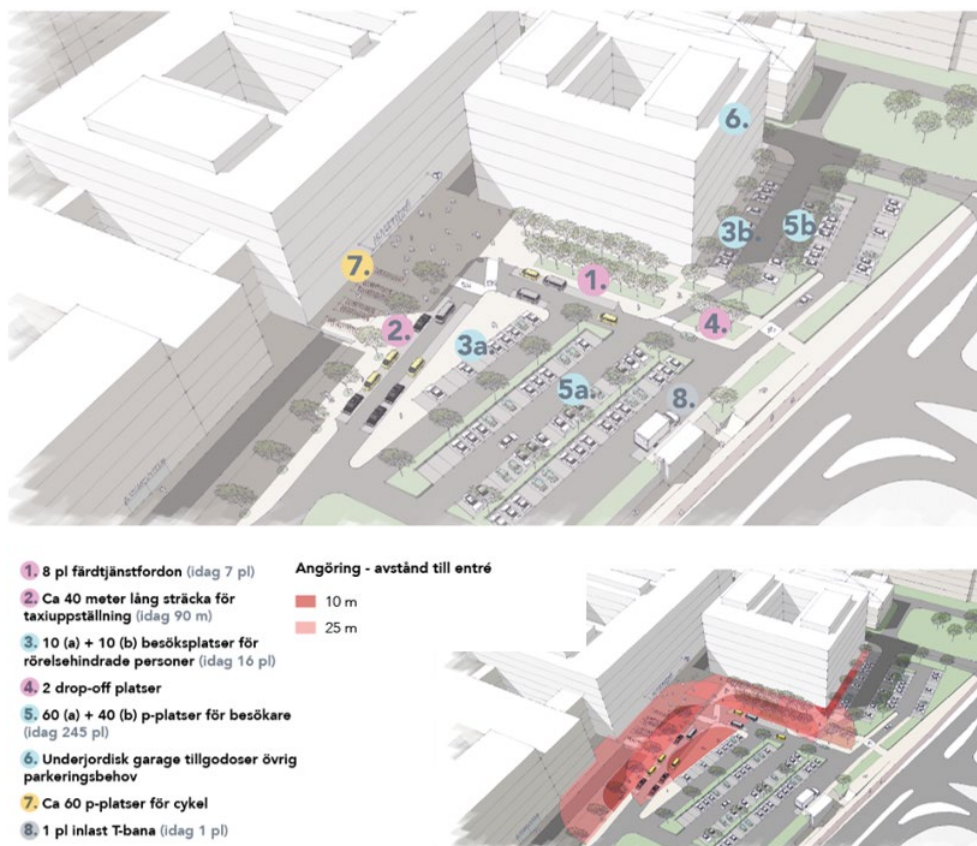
Entrézon enligt planförslagets illustrationsplan.
